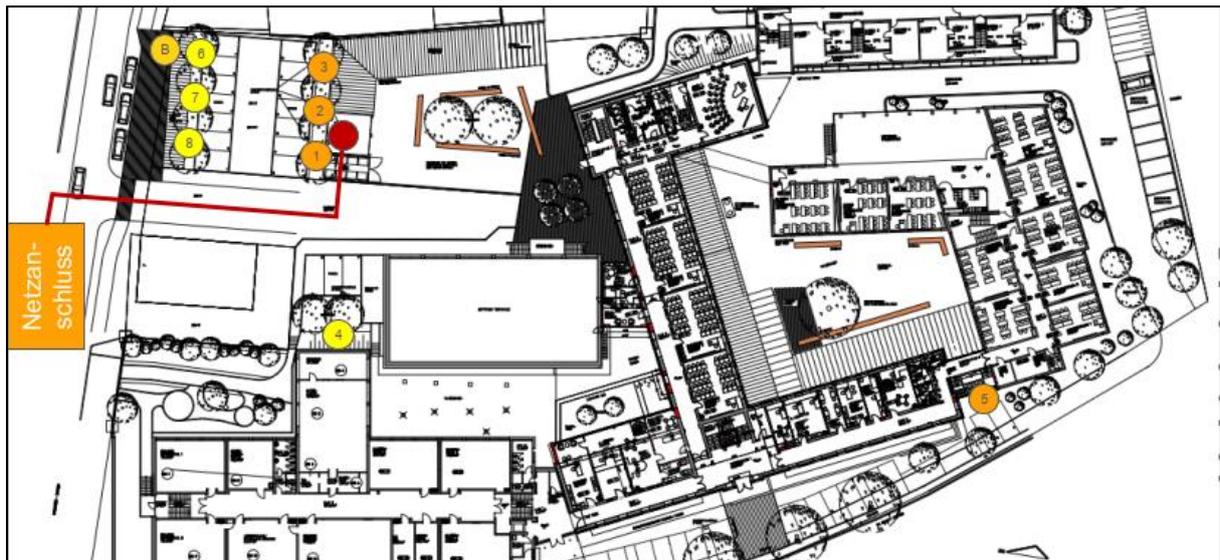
Eingabeplan mit Erstentwurf zum Ladepunktaufbau
